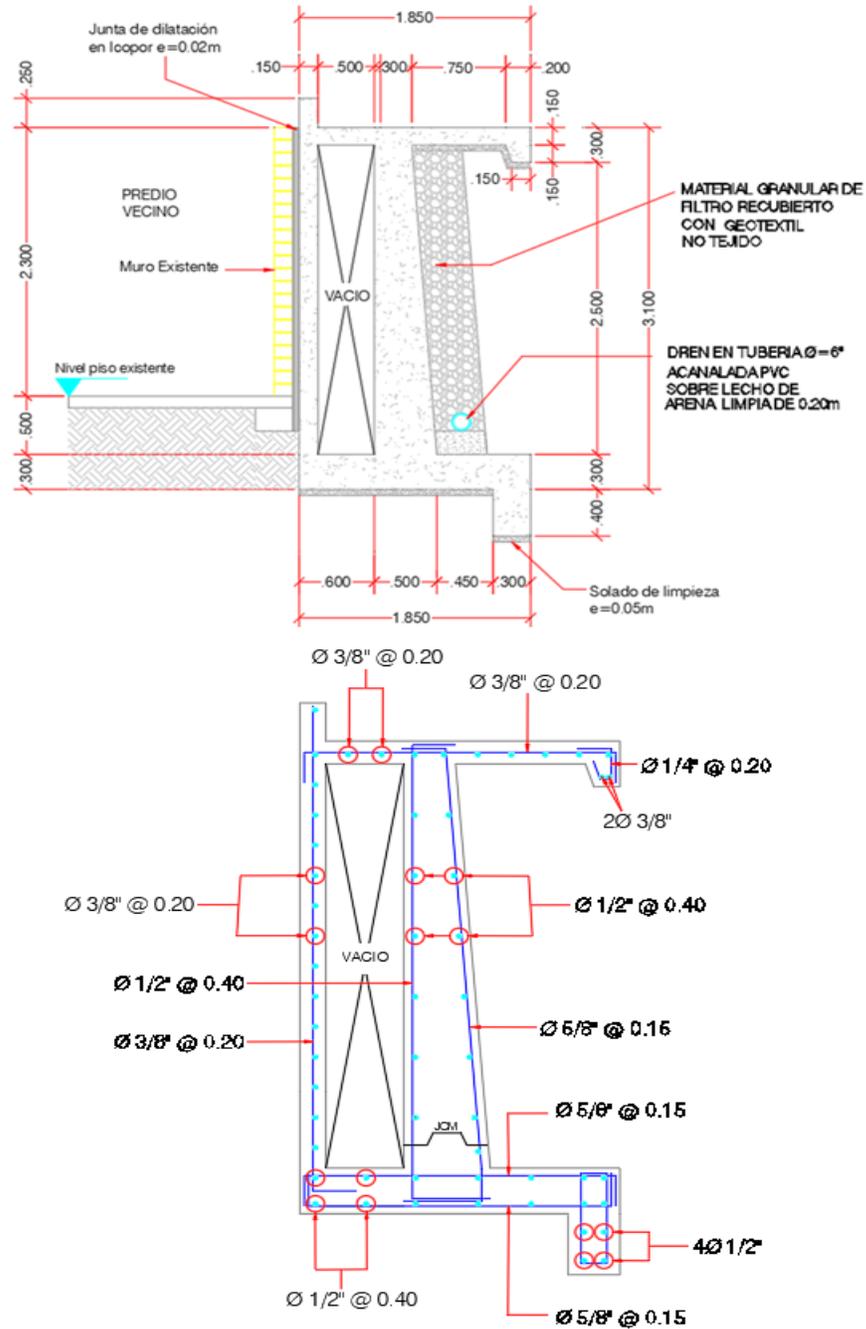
Detalle de geometría y aceros del muro de acceso vía principal.
